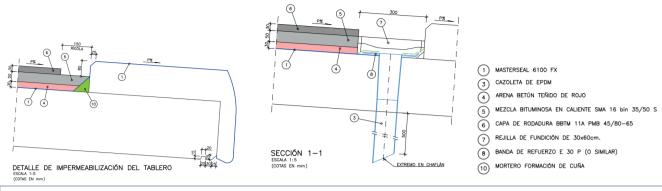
Detalles de remate de la impermeabilización y pavimento en general (izq.) y en zona de desagüe (der.).
